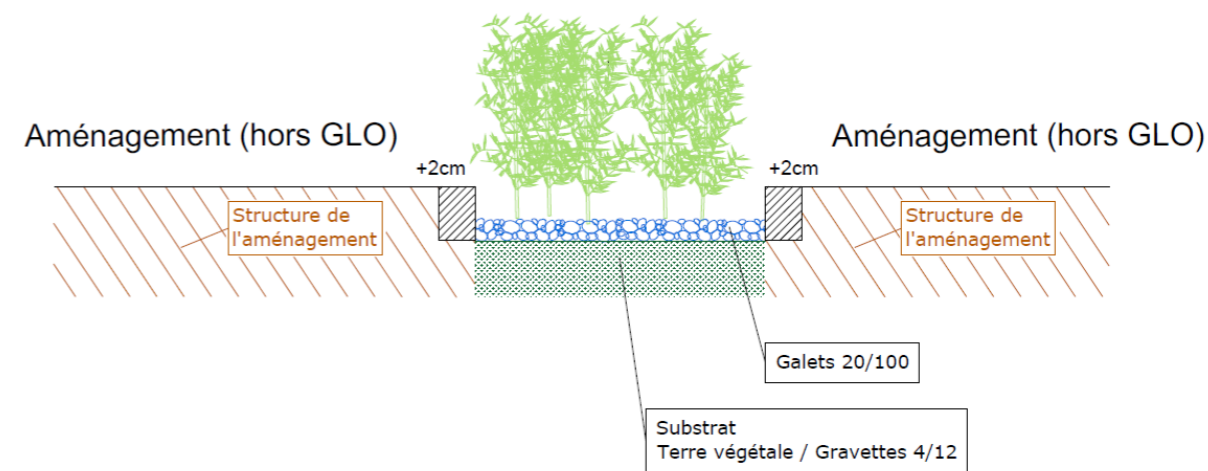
COUPE-TYPE D'UN OUVRAGE DE TYPE "JARDIN DE PLUIE"
